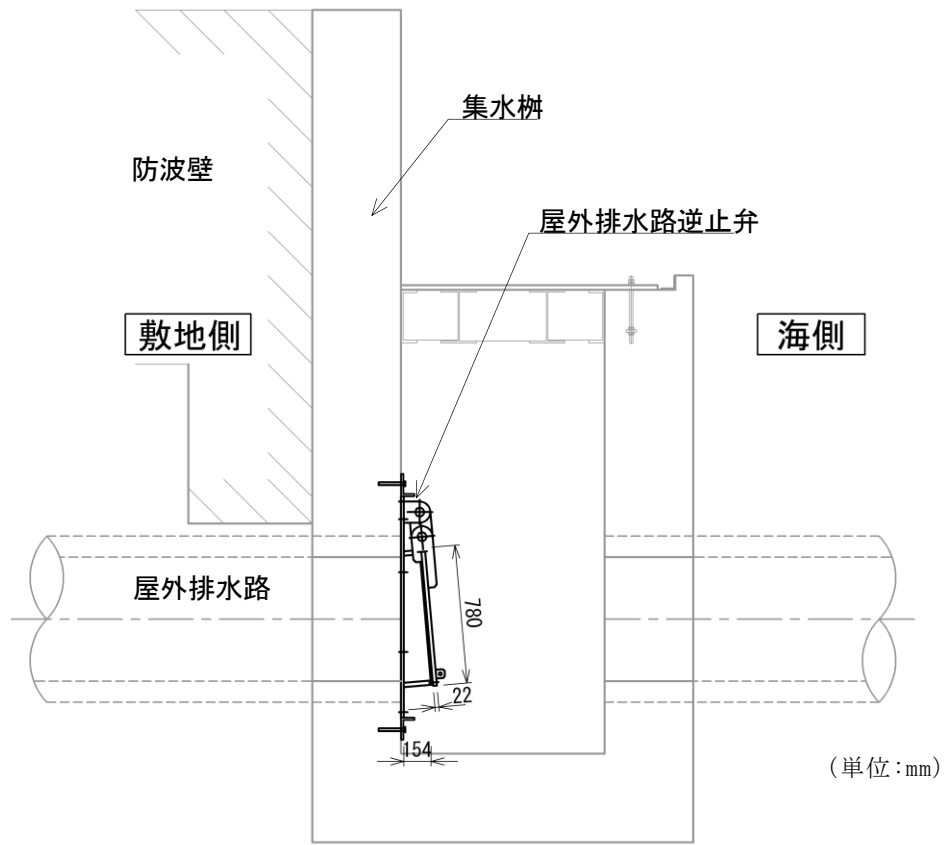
(2) 屋外排水路逆止弁⑦の構造概要図
